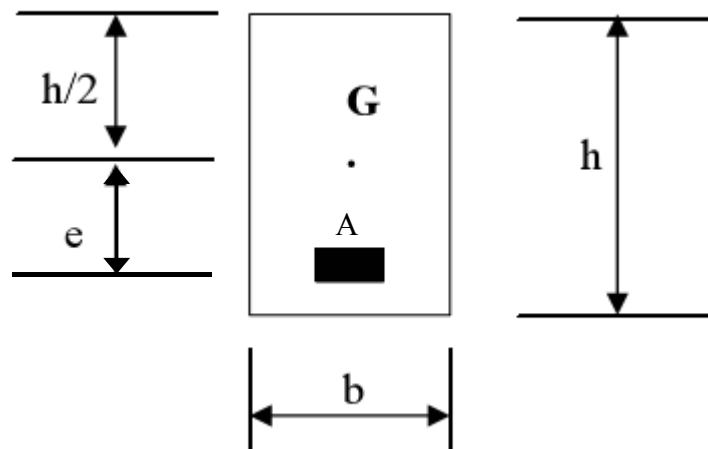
Homogénéisation de la section en béton armé [6]
